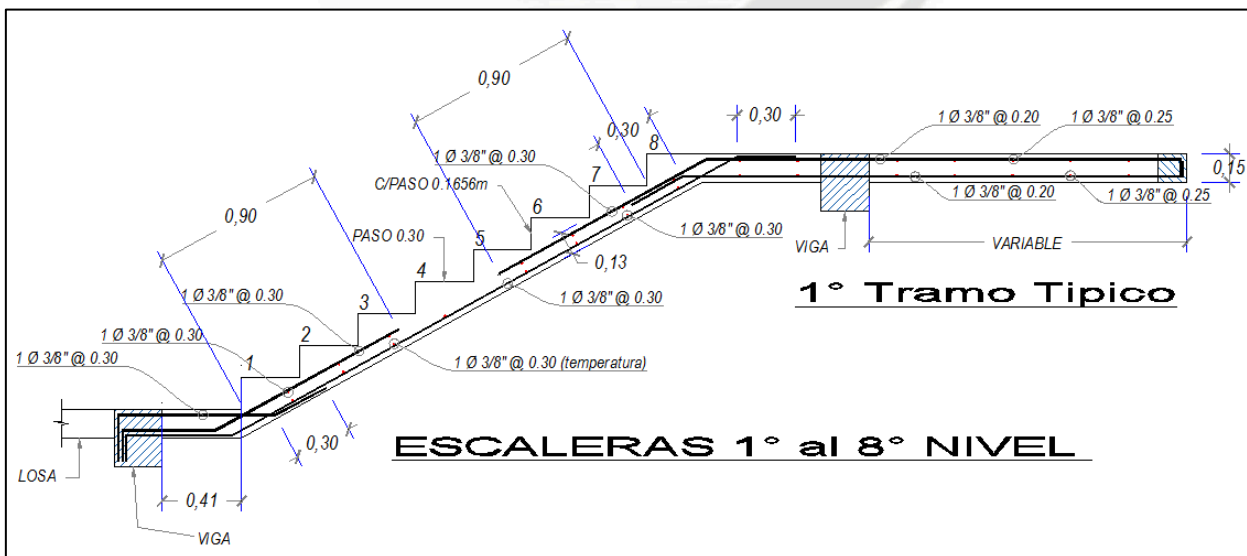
Diseño final de escalera tramo de ida del primer piso al primer descanso.
